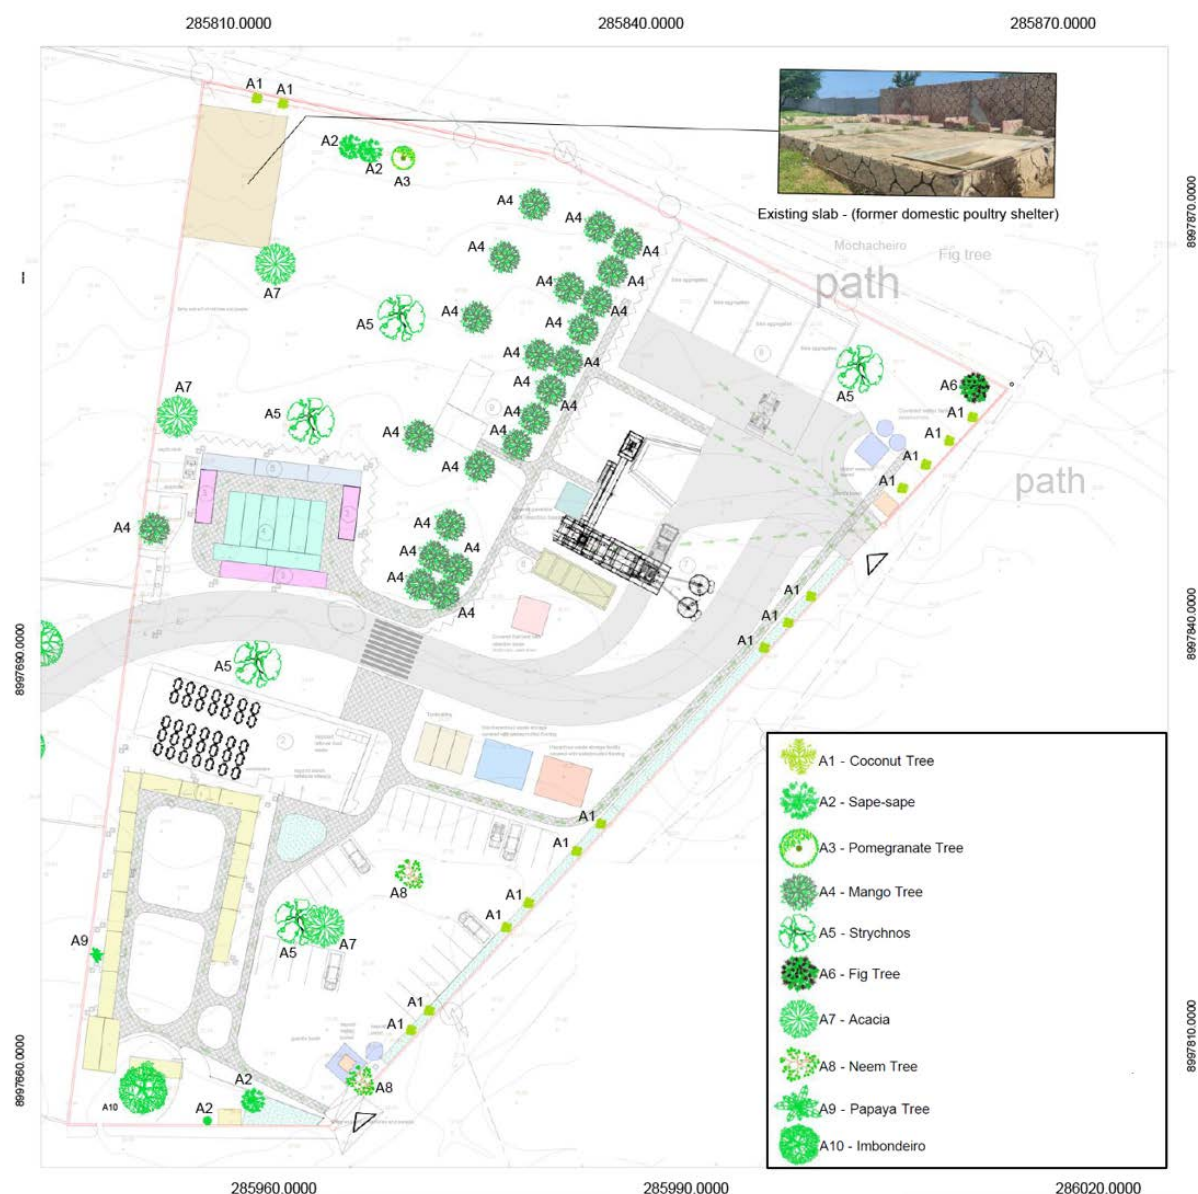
Árvores localizadas no Estaleiro de Apoio à Construção (Fonte: Griner, 2026)
